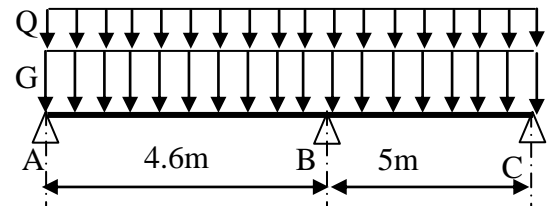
schéma statique d'une poutrelle sur trois appuis
